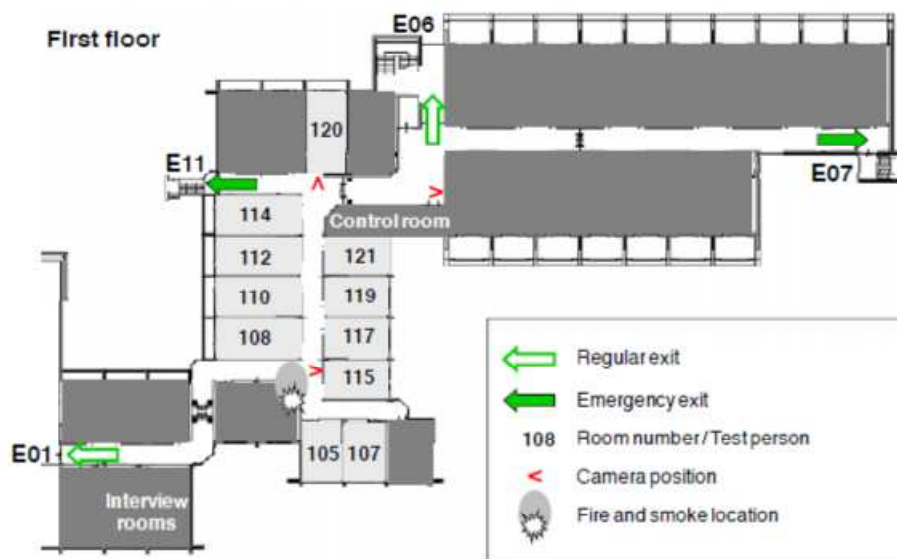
17 – Planimetria del piano dell’hotel sottoposto al test
